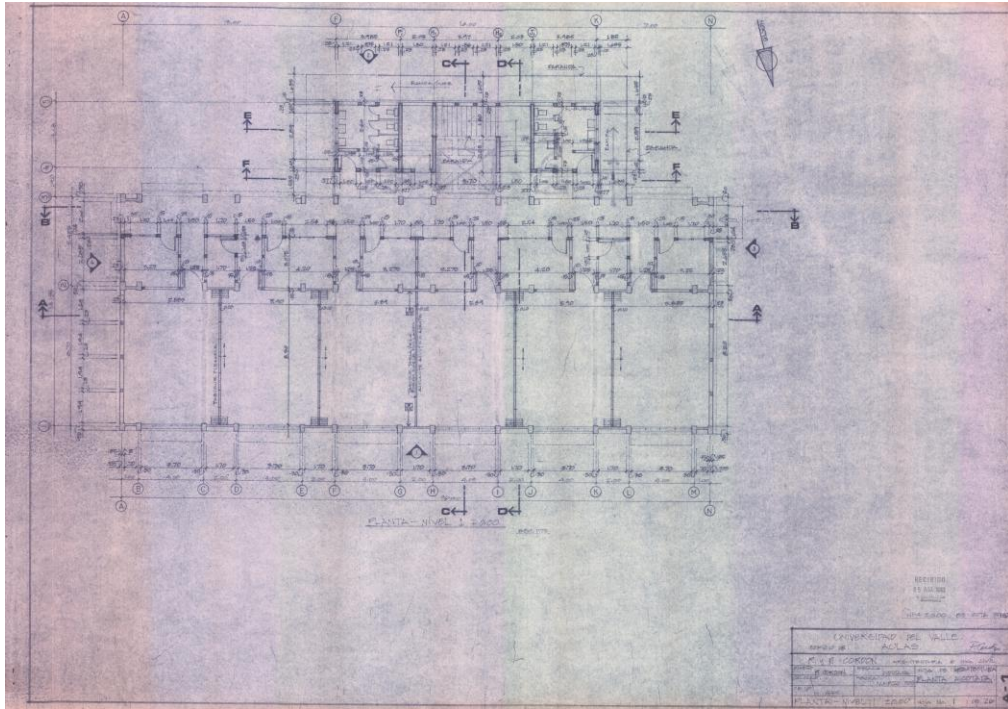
Plano de planta nivel 1 Edificio A en Universidad del Valle de Guatemala, Campus Central. Por R. y P. Córdón Arquitectura e Ing. Civil (1983)
